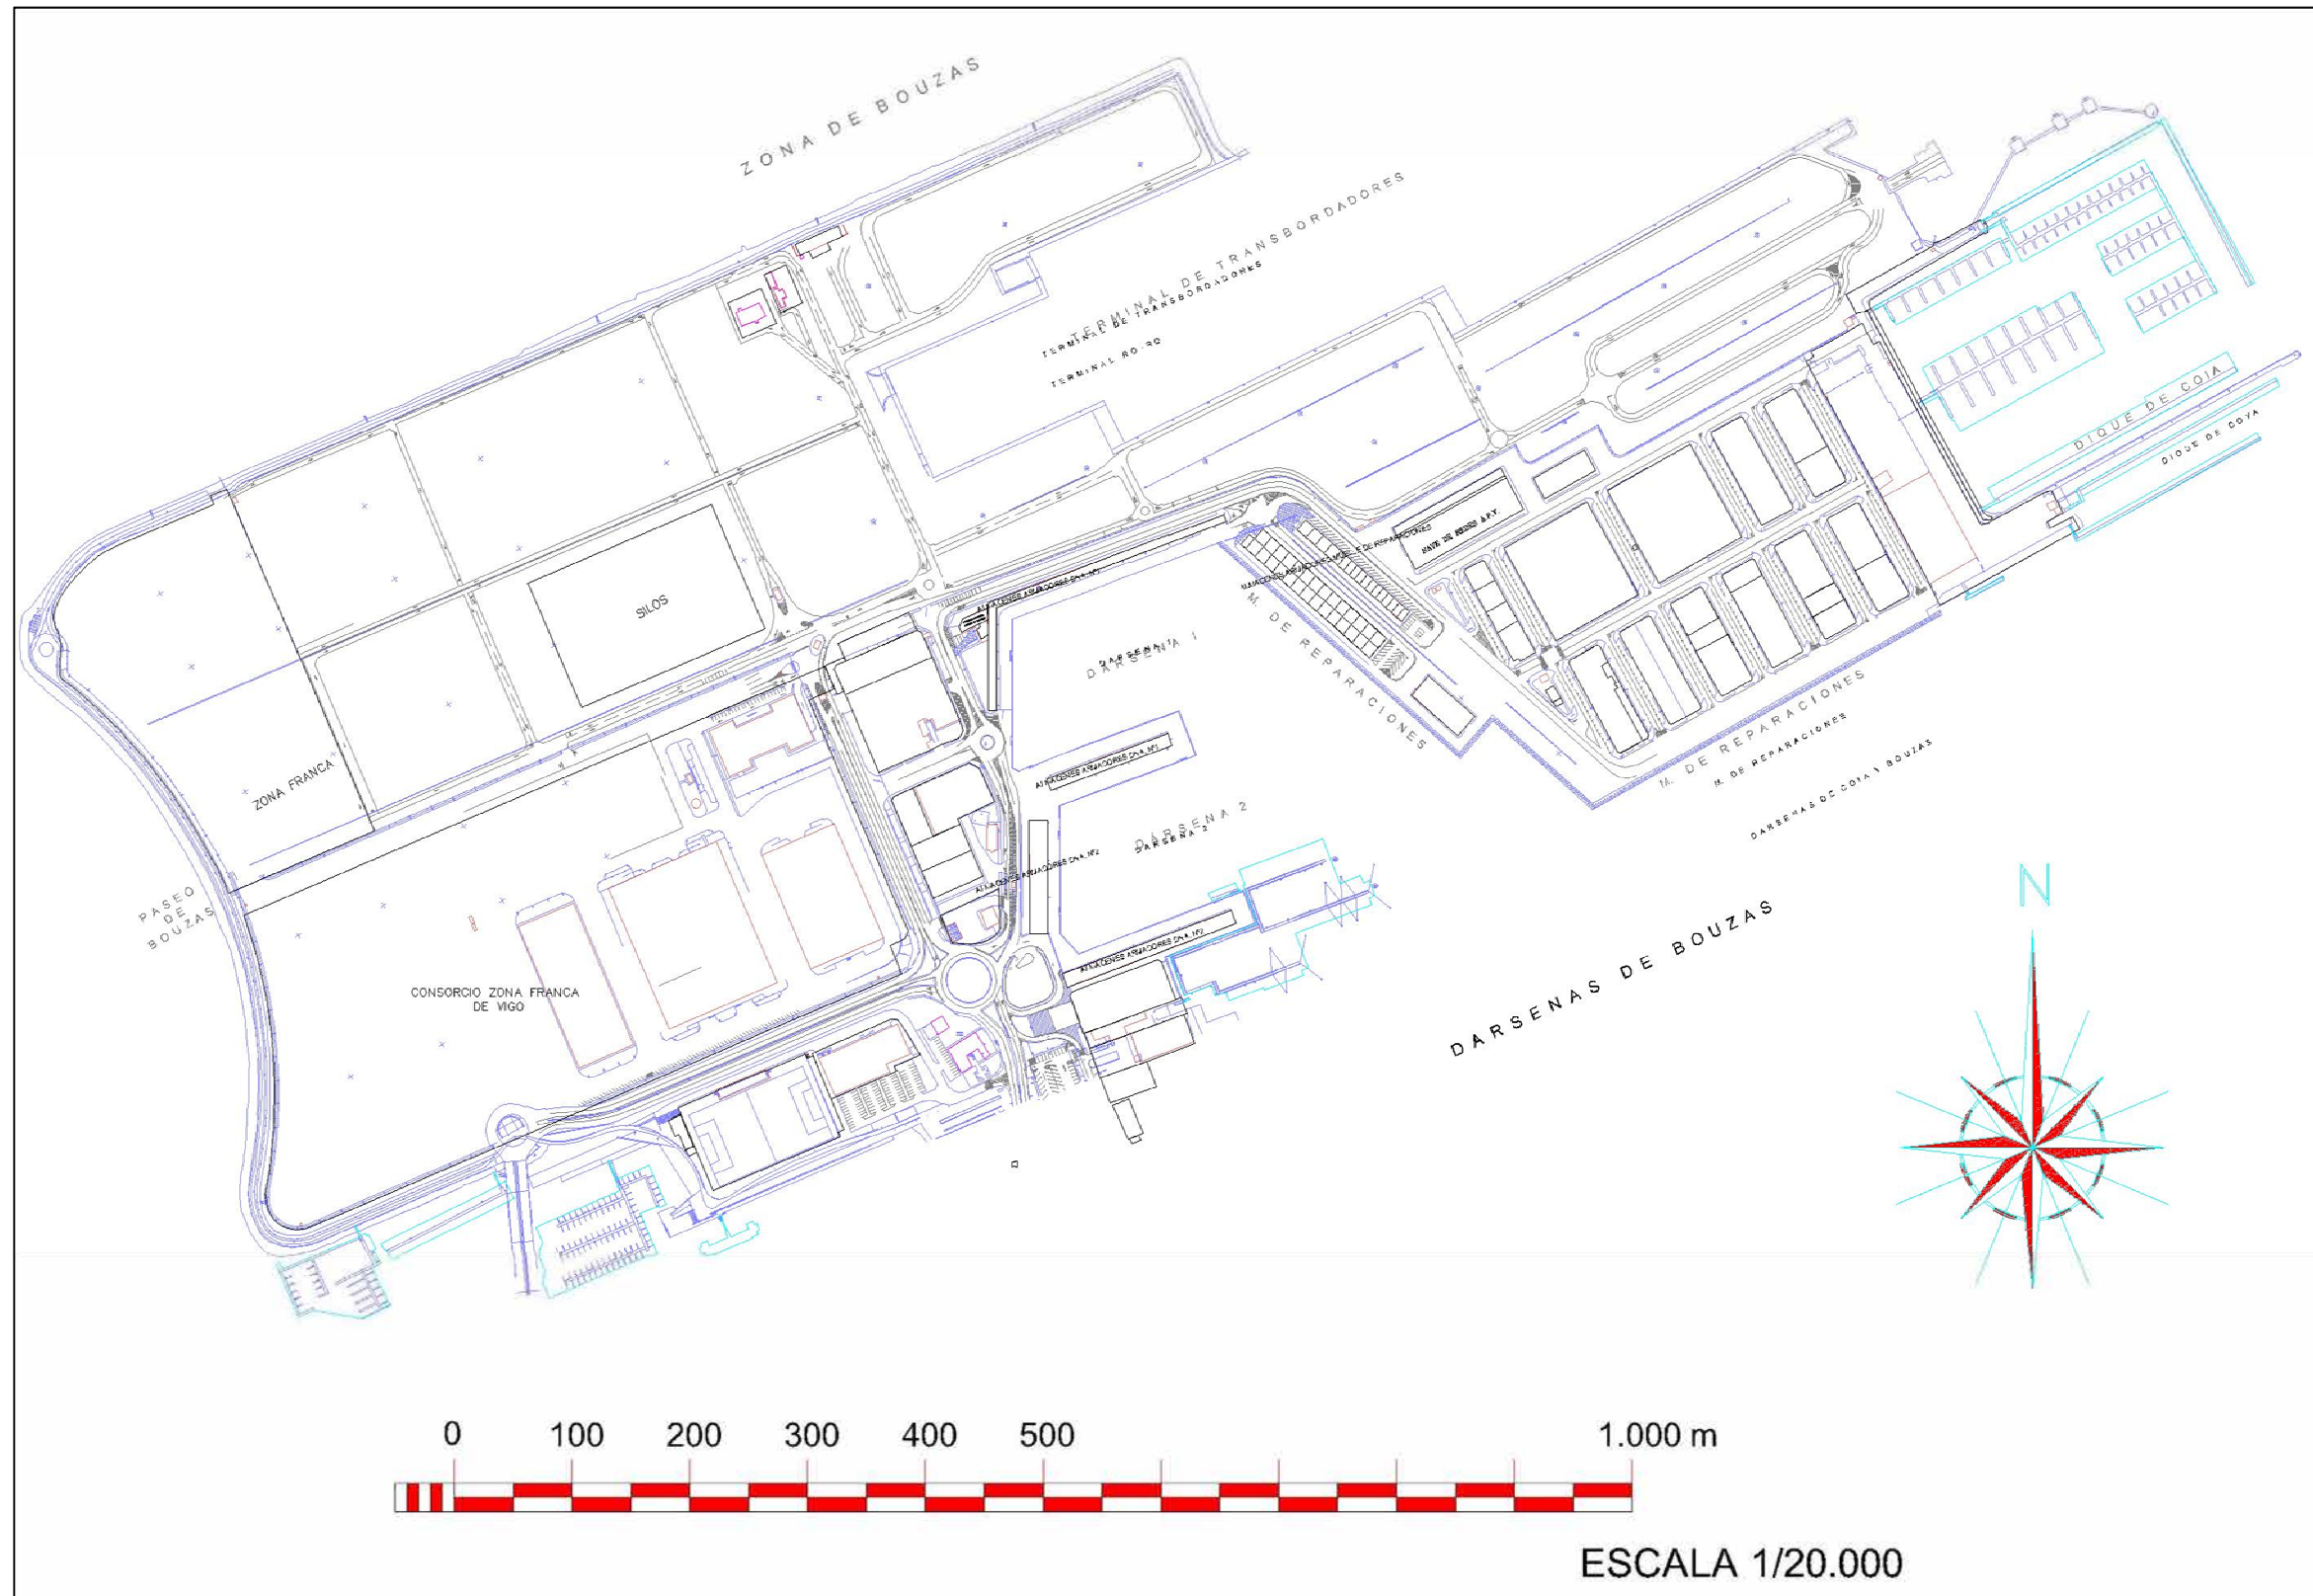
Plano general de planta. Fuente: Autoridad Portuaria de Vigo
